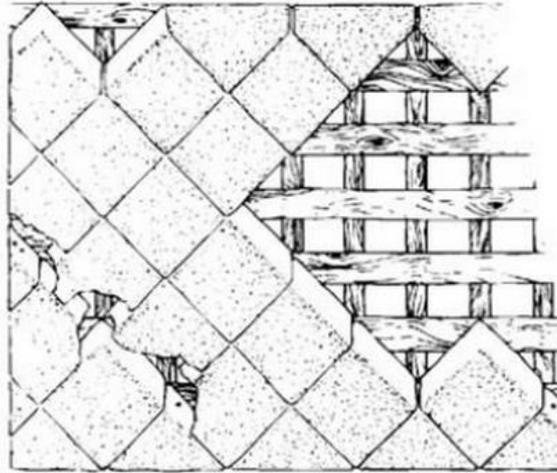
Detalle de cubierta resuelta con ladrillos de adobe, según J.P. Adam (1996)
